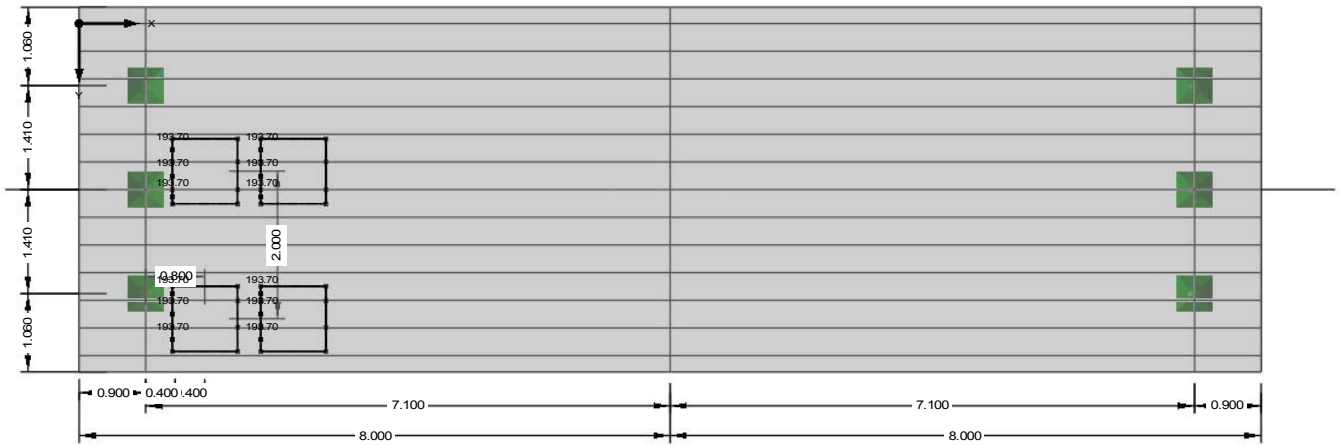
Darstellung der Angriffsflächen der Achslasten im Grundriss
